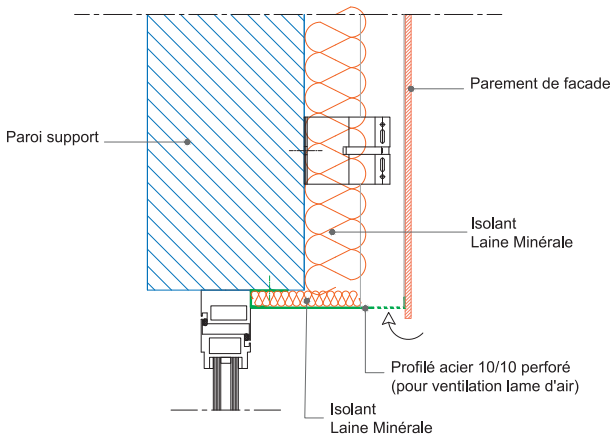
Coupe verticale encadrement de la baie niveau linteau
